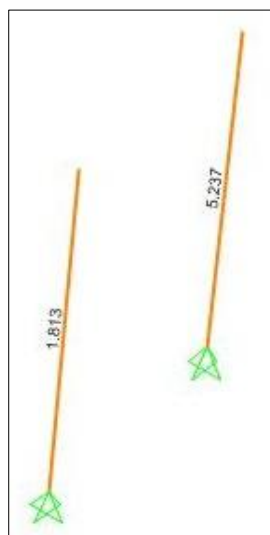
Armadura longitudinal nos pilaretes das escadas
